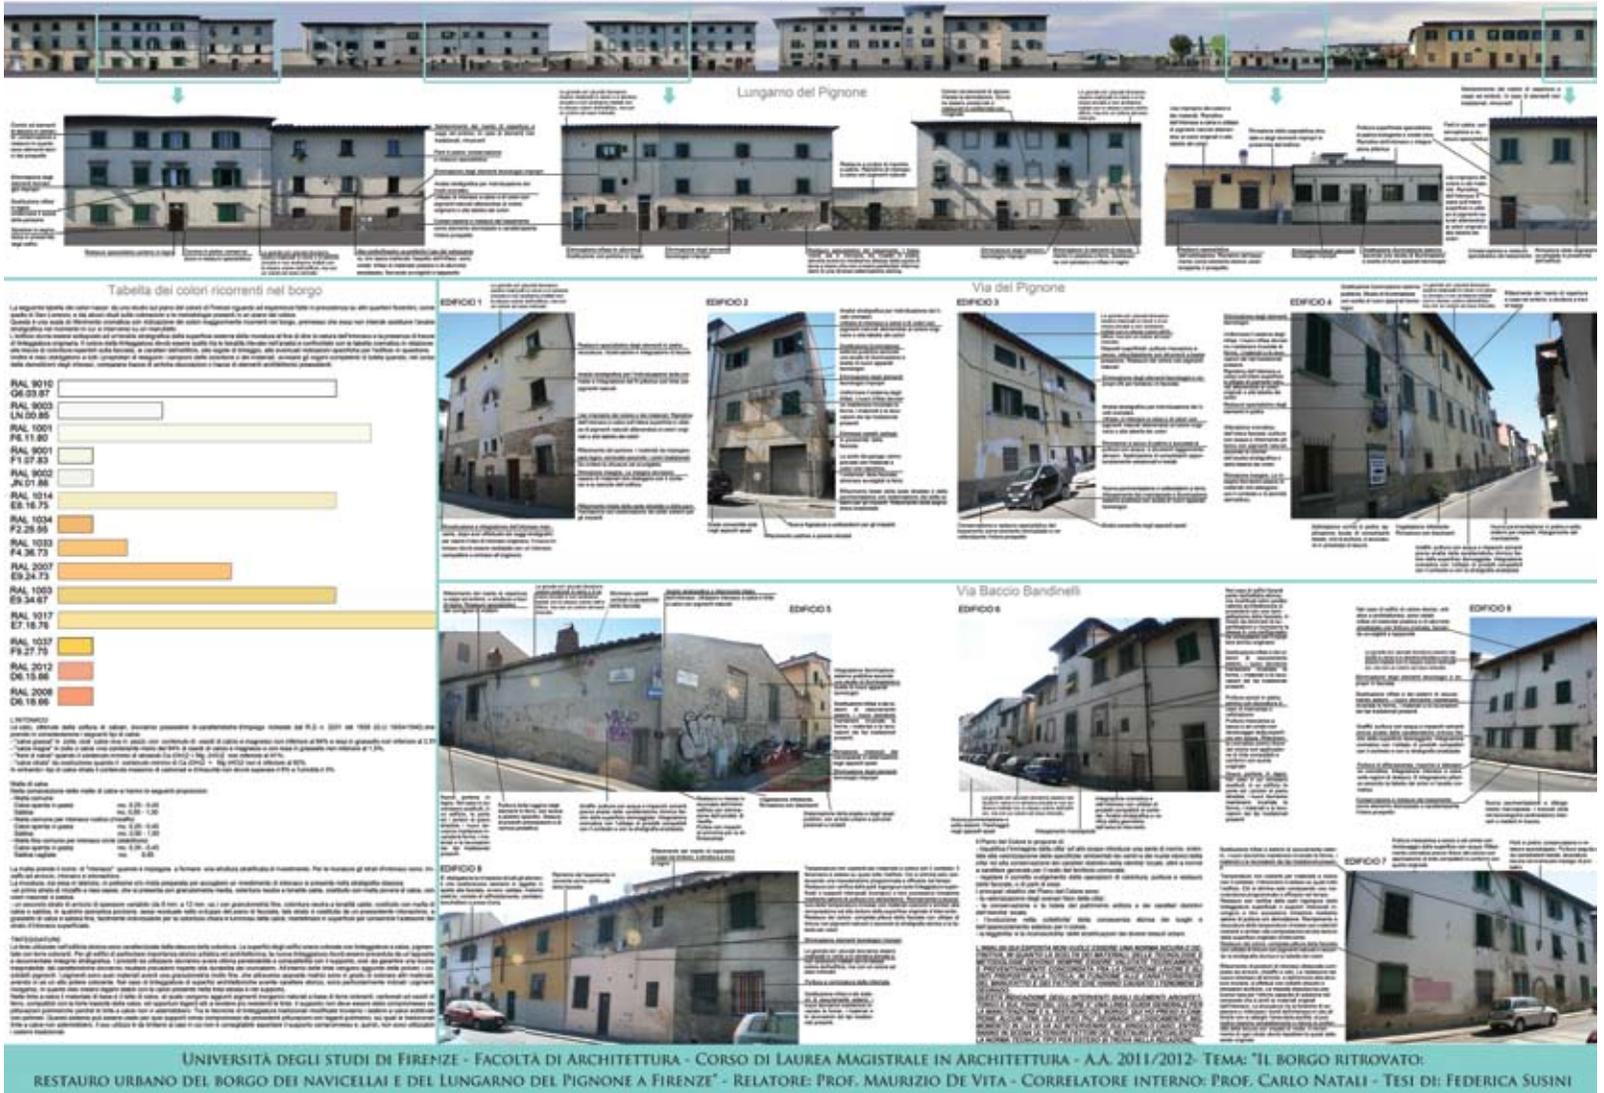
Indicazione degli interventi sugli elementi architettonici e sul piano del colore
